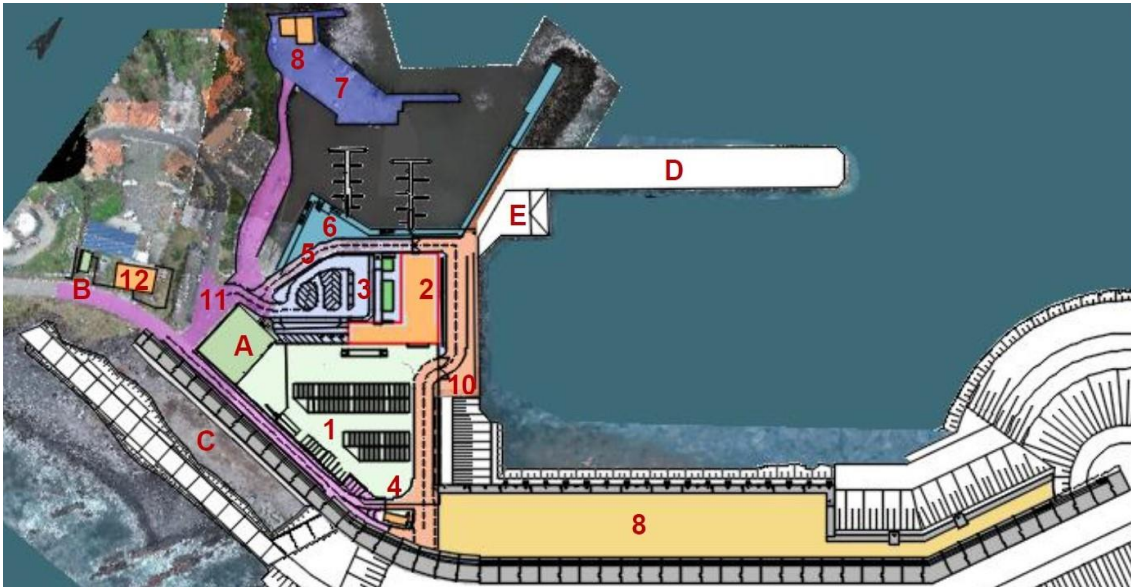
Redes técnicas – Novo layout geral do novo Porto das Lajes das Flores (Projeto)
